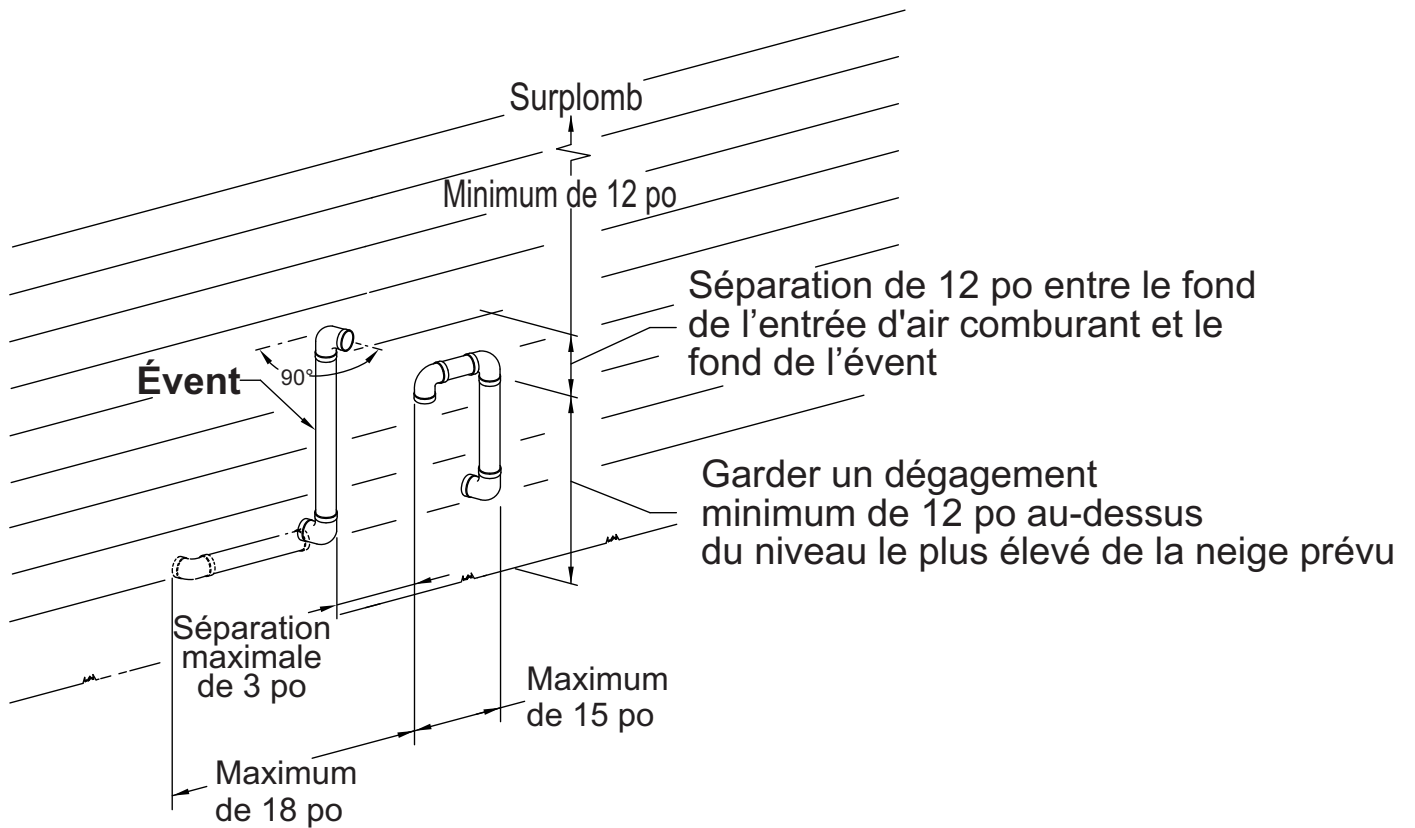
B - Terminaisons d'évent / d'entrée sur un mur latéral - Dégagement de 12 po ou plus au-dessus du niveau du sol
